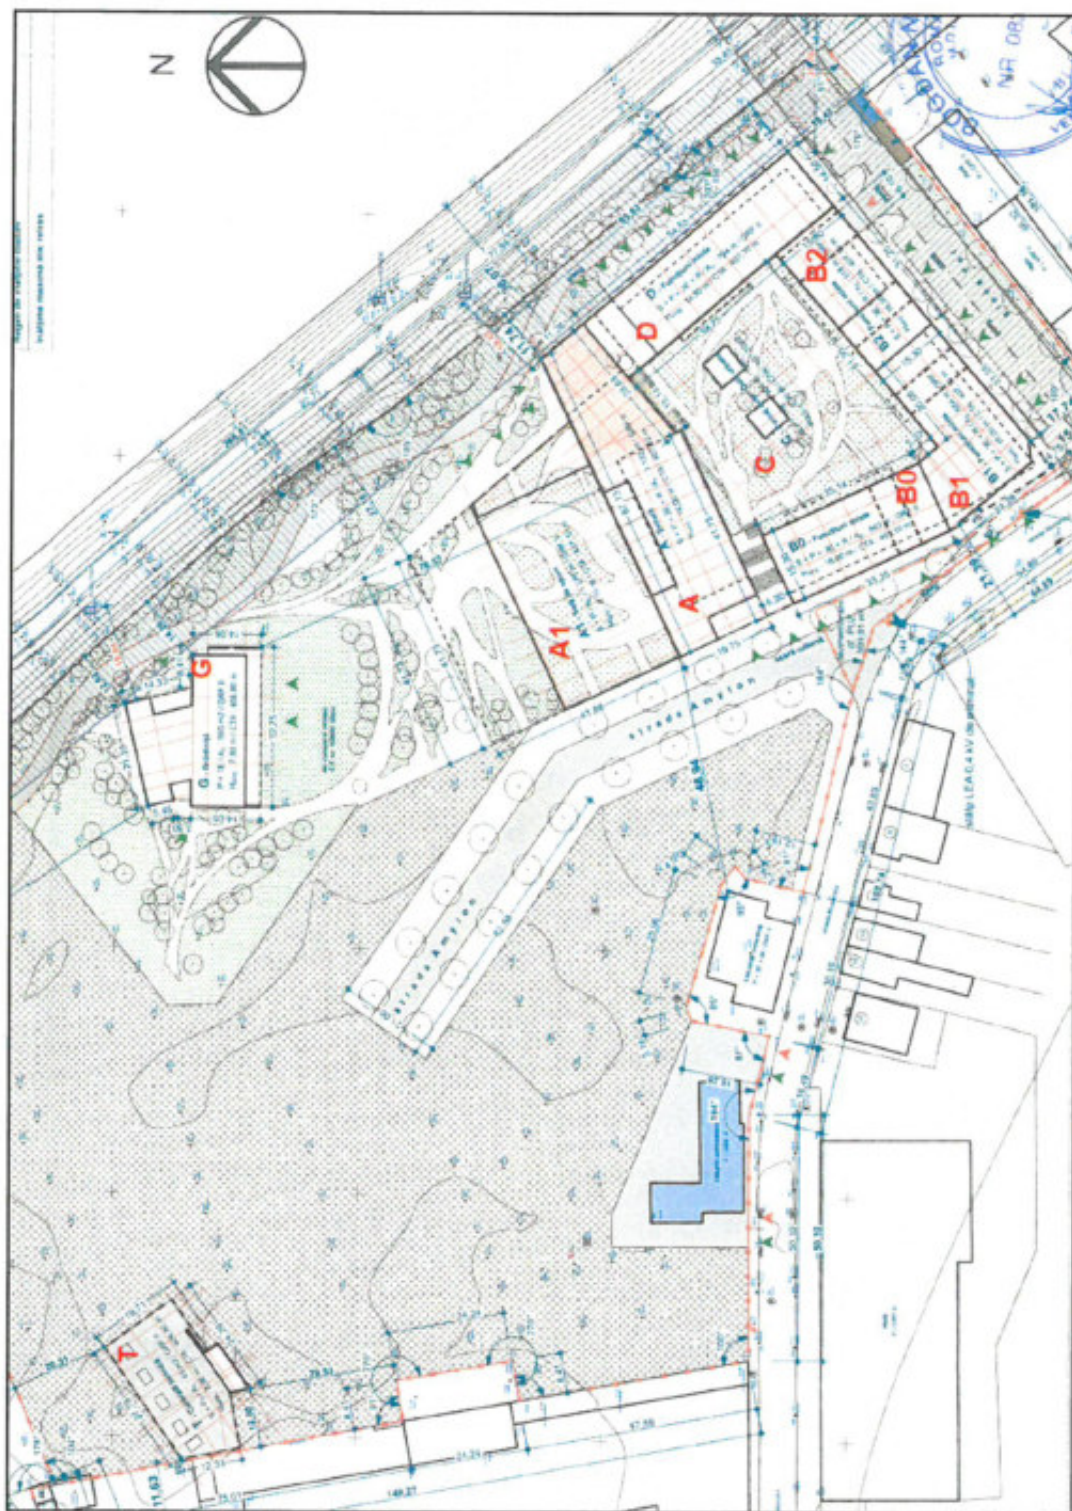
Plan privind situația propusă – extras din planșa A-00-02, faza DTAC
